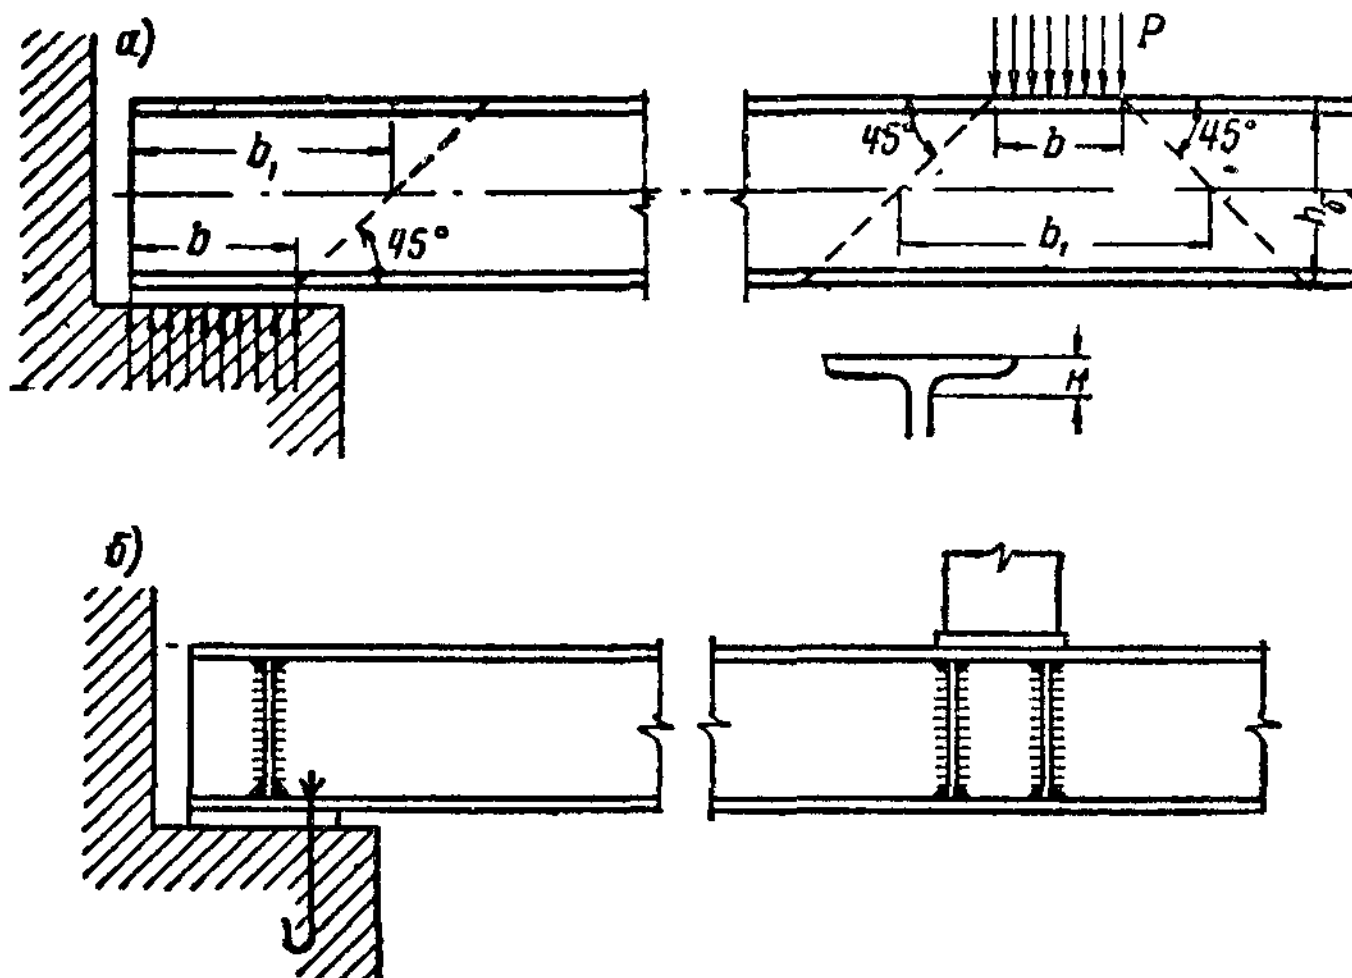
К проверке стенки прокатной балки на сжатие и укрепление ее ребрами
